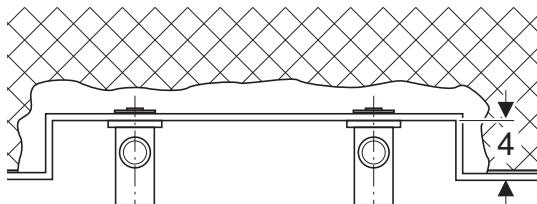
Монтажные размеры для скрытого монтажа с использованием ступенчатой монтажной панели Geberit
